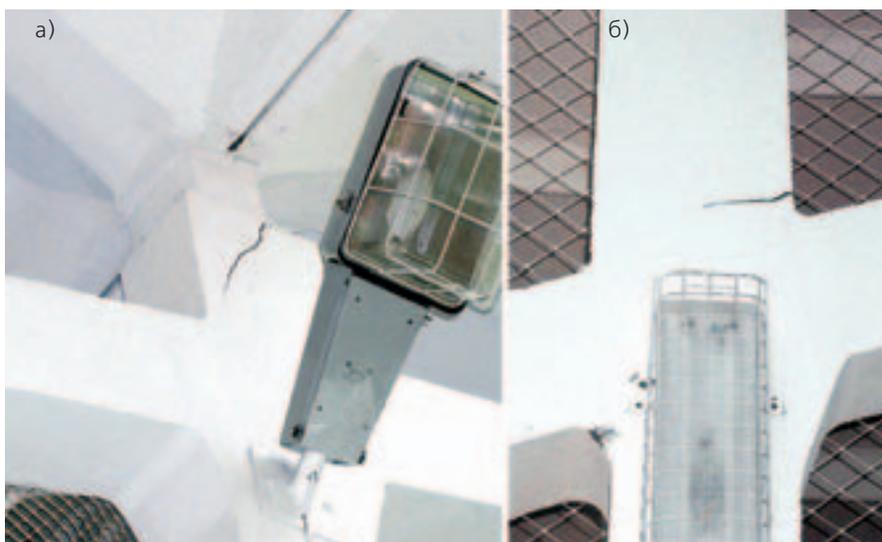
Характерные трещины в удлиненных железобетонных стойках обследованных ферм (а – скалывание оголовка, б – трещина над верхним поясом)
